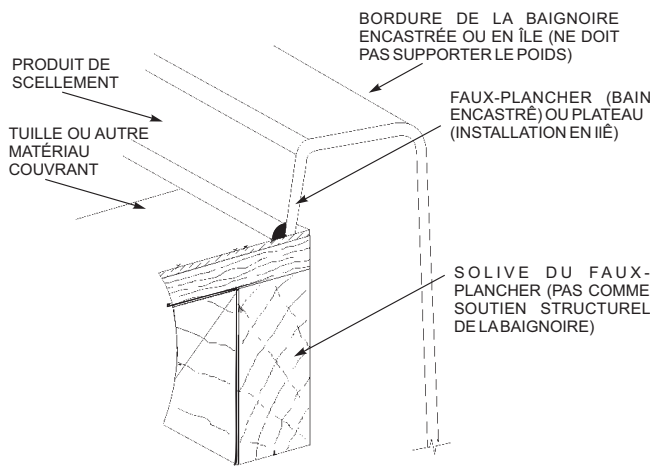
MÉTHODE POUR SUPPORTER LA BORDURE D'UNE BAIGNOIRE ENCASTRÉE OU EN ÎLE
